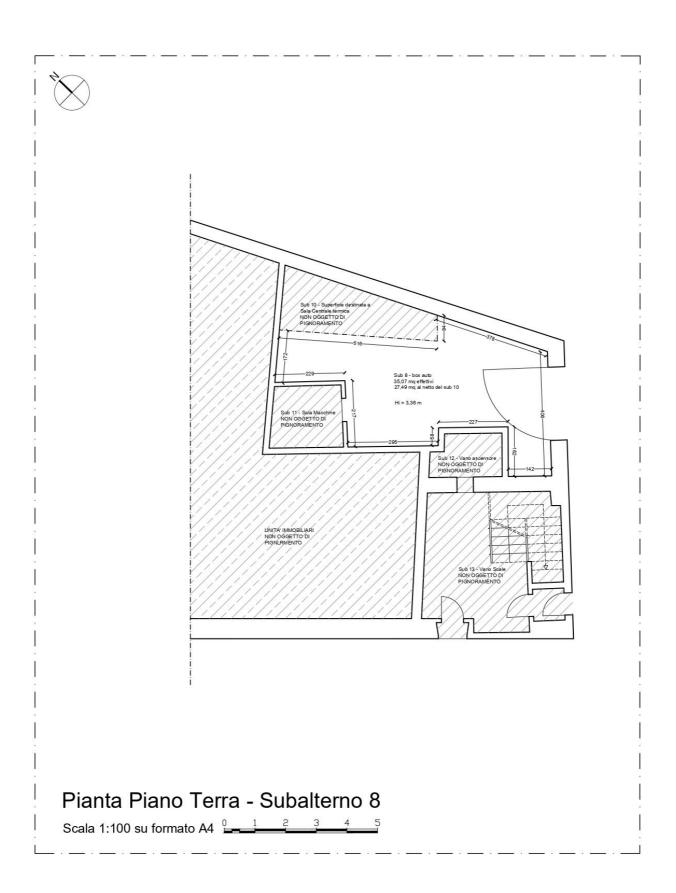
Piano Terra – Subalterno 8 Planimetria dello stato di fatto rilevato
